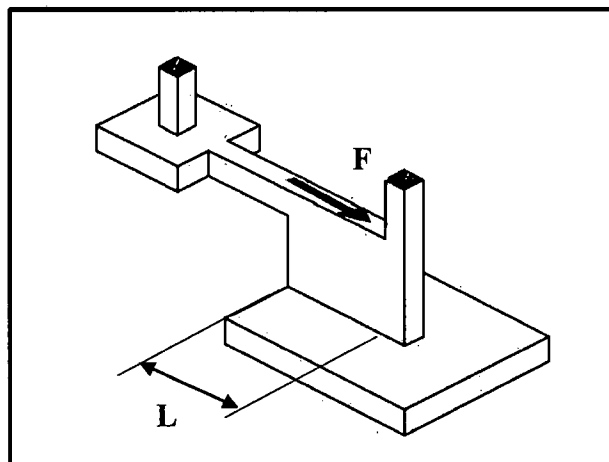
Alternativa planteada usando placas para absorber fuerza cortante.
